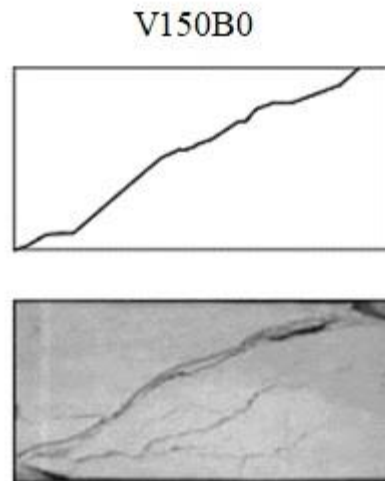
Padrão de fissuração da viga V150B0.
